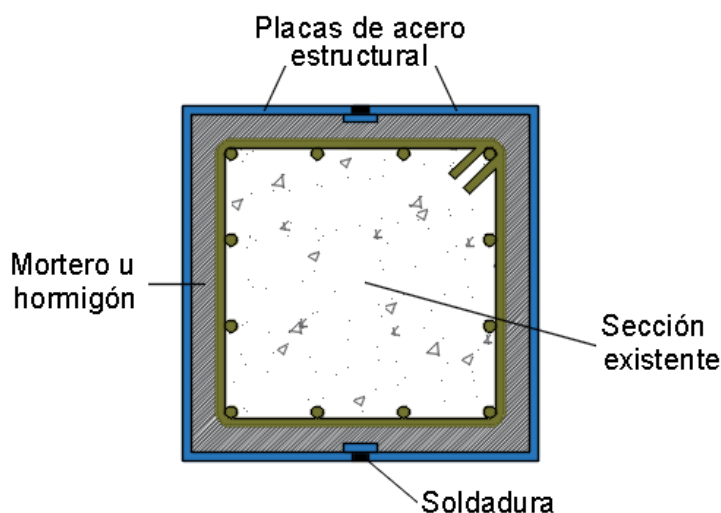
Encamisado usando estribos exteriores soldados
